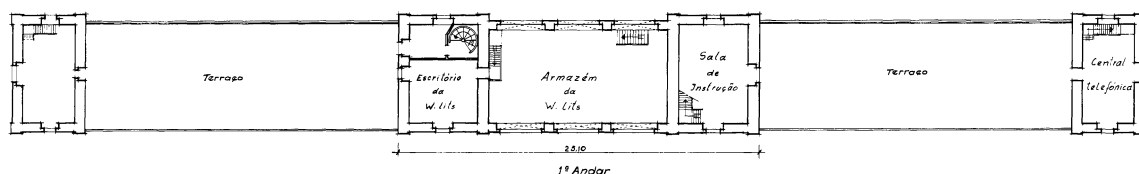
Estação Ferro- Fluvial Barreiro Mar – Planta Piso 1 – Fachada Poente
